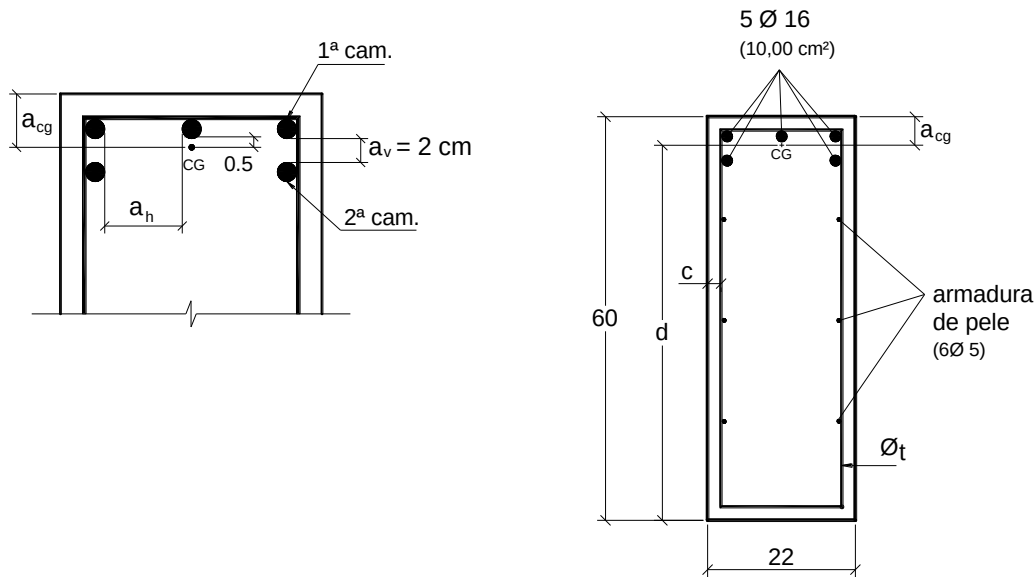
Detalhamento da armadura negativa na seção transversal.
